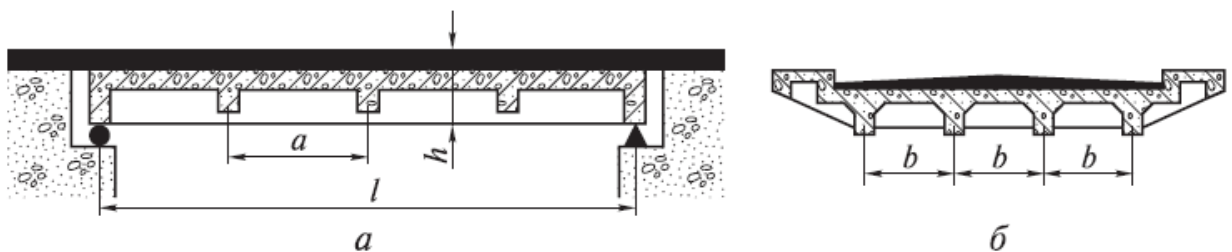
Фасад (а) и поперечное сечение (б) рёбристого монолитного железобетонного пролетного строения
